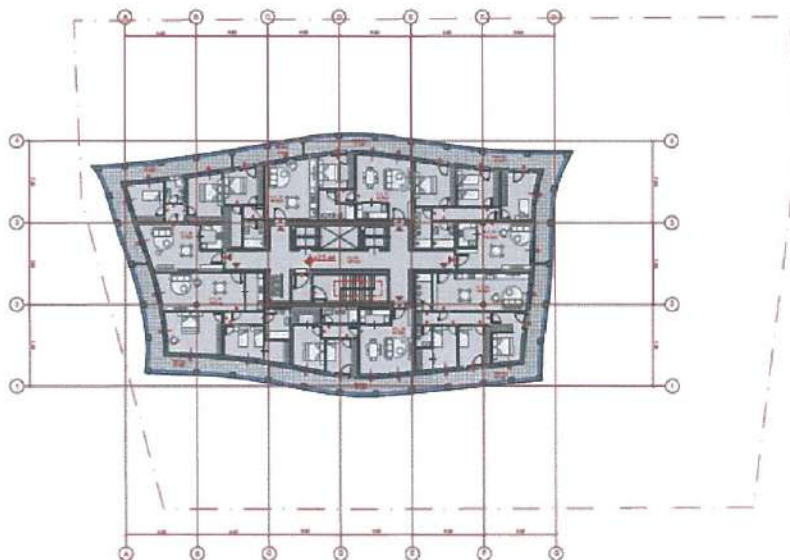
Planimetria e katit 5, në kuotën +22.44 SIP 918 m²
